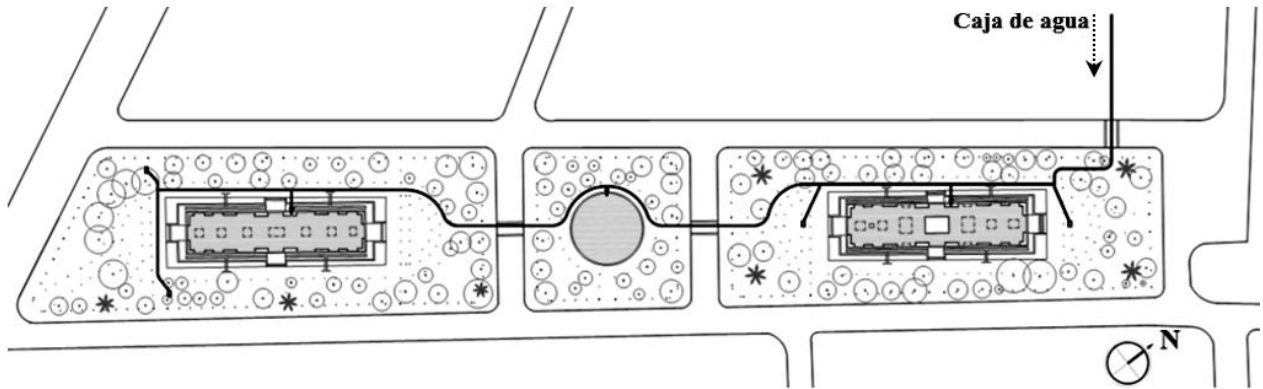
Plaza de Casa Forte. Sistema de hidráulica identificado en 2014. Fuente: Laboratorio del Paisaje/UFPE.
